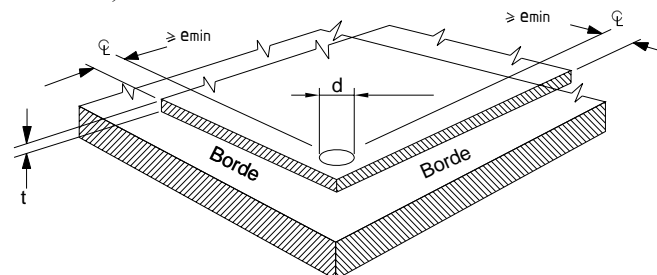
Distancia de Borde para Puntos de soldadura por arco – Plancha Simple
